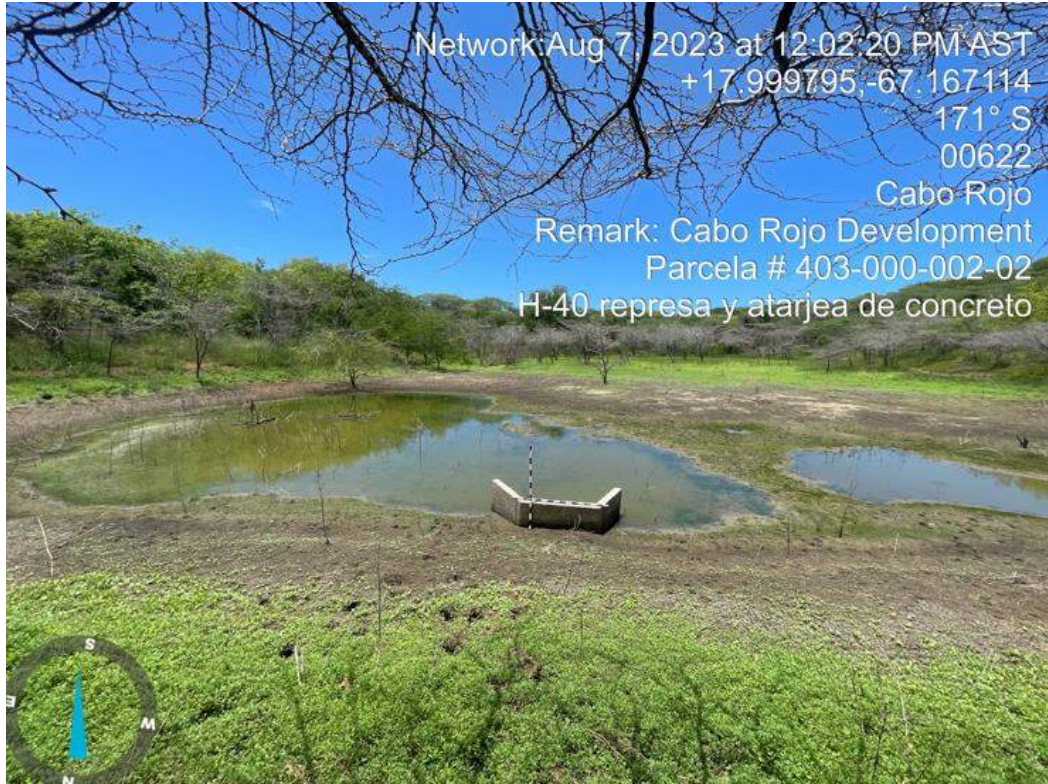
Elemento H-40. Represa y atarjea de concreto.
